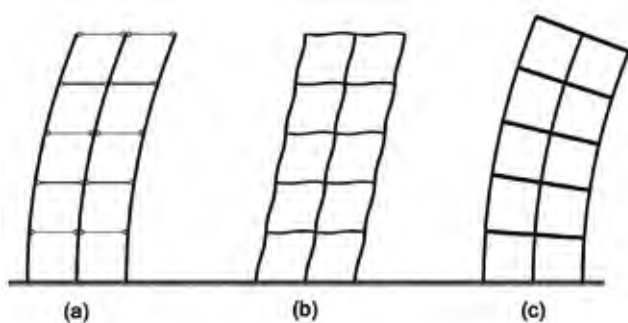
Deformación de una estructura pórtico ante acciones laterales en los casos: a) vigas de rigidez despreciable; b) vigas de rigidez normal; c) vigas muy rígidas
